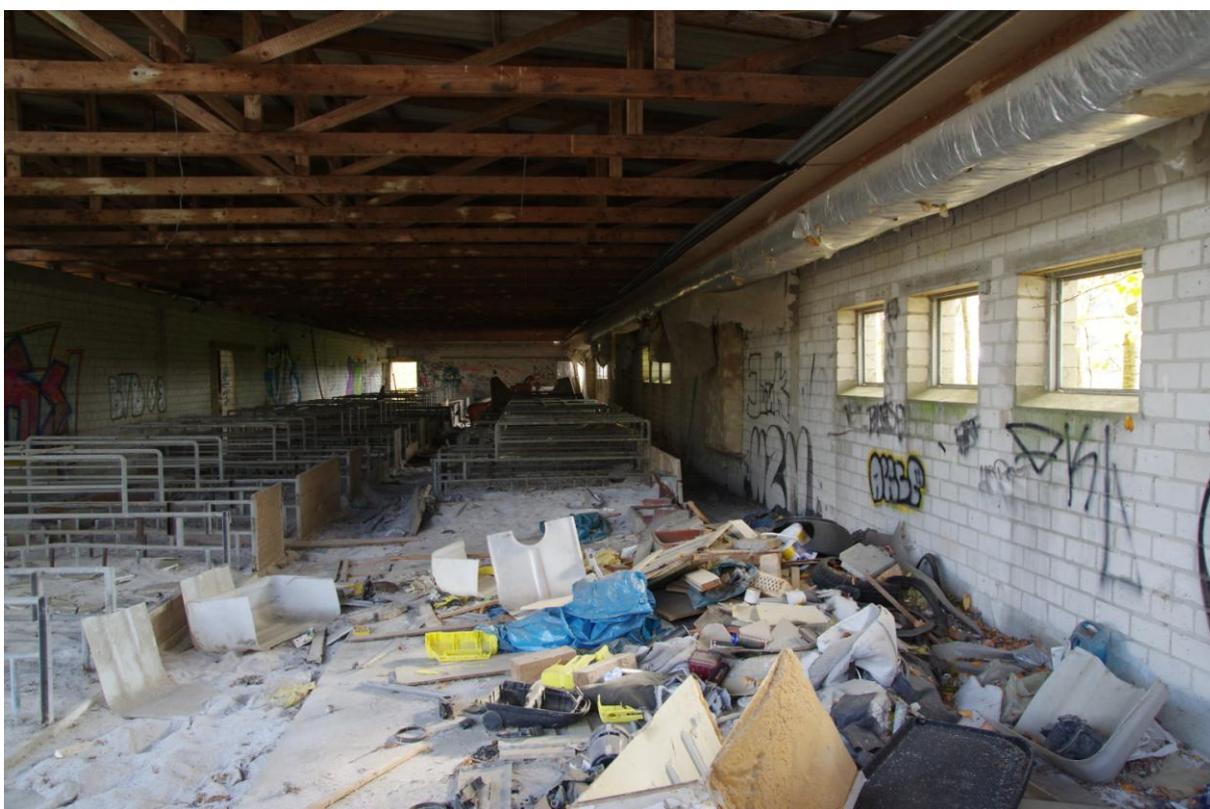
Innenraum und Müllablagerungen in einem ehemaligen Stall im südlichen Plangebiet.
